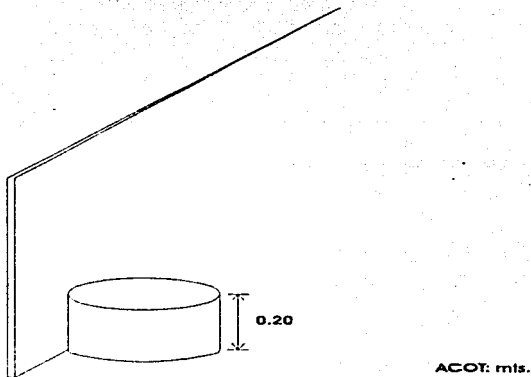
Saladero construido con una cubeta de 20 litros recortada
